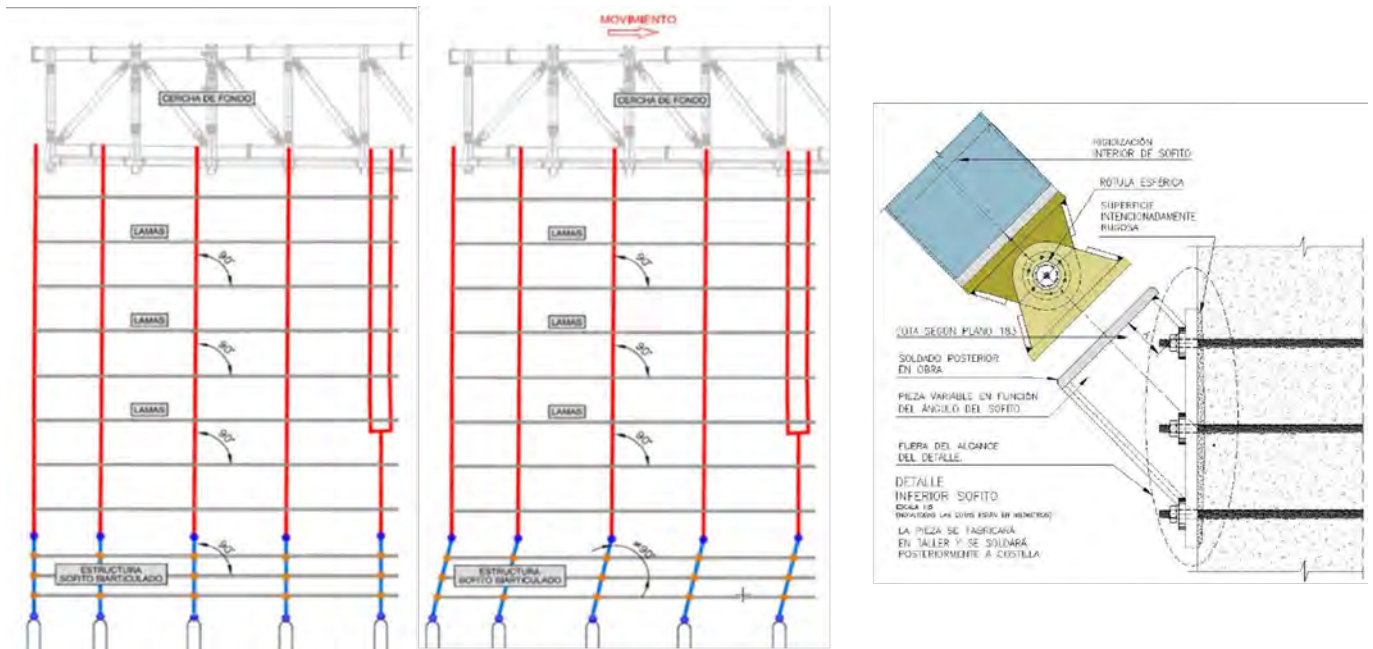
Izquierda: Esquema de desplazamientos de fachadas N-S en dirección E-O. Derecha: Conexiones tipo puntal sofito a pantallas hormigón.
